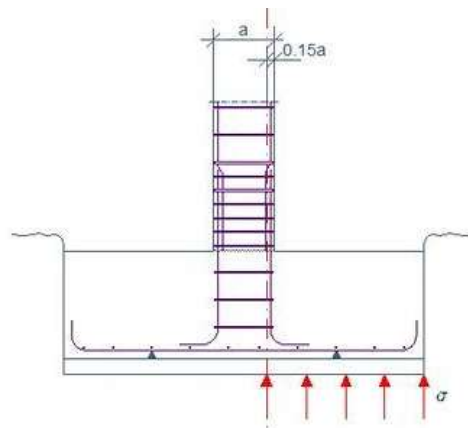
Zapata aislada, Fuente: [www.google.com](http://www.google.com)
